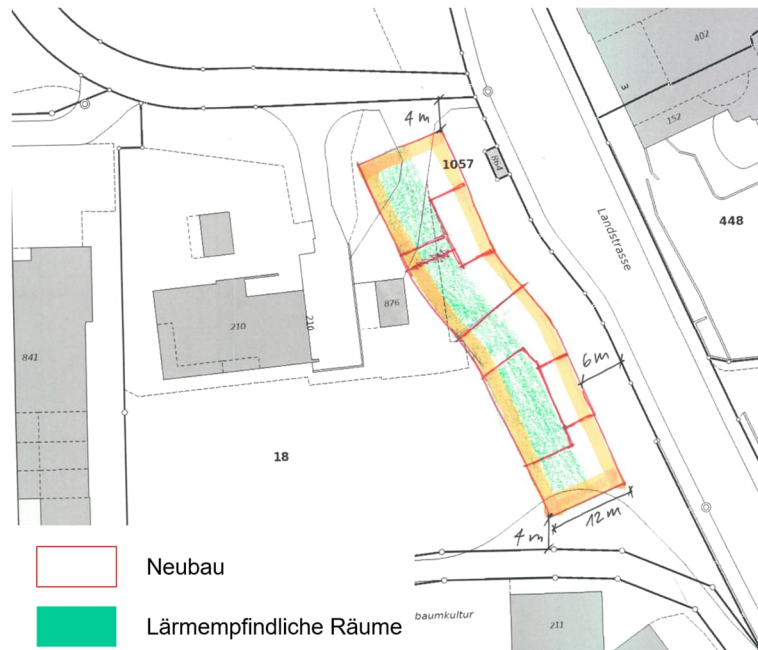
Möglicher Neubau mit lärmoptimierten Grundrissen
